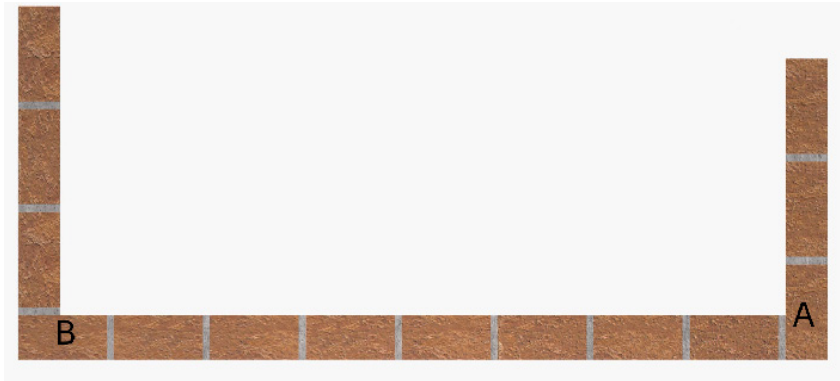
Esquema de la traba de ladrillos en paredes transversales
